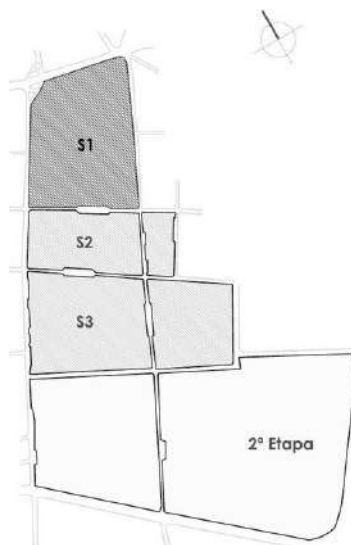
Plano sectorizado Villa Frei. Fuente (Swanston, 2014).
